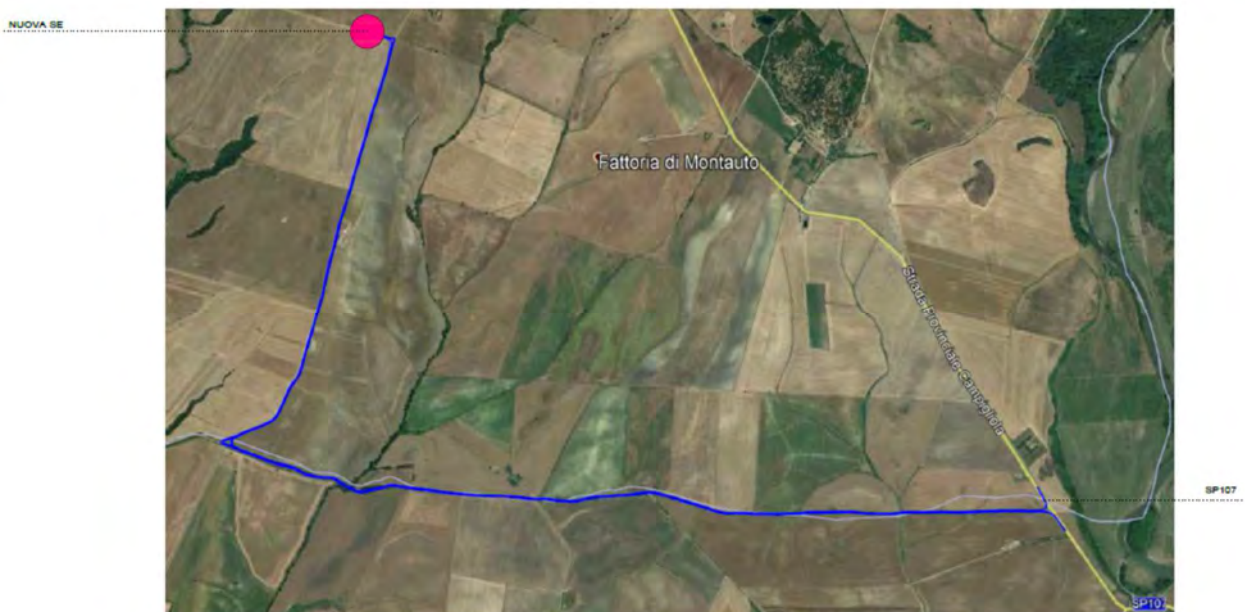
Vista della viabilità da adeguare di accesso alla Stazione Elettrica in progetto.
